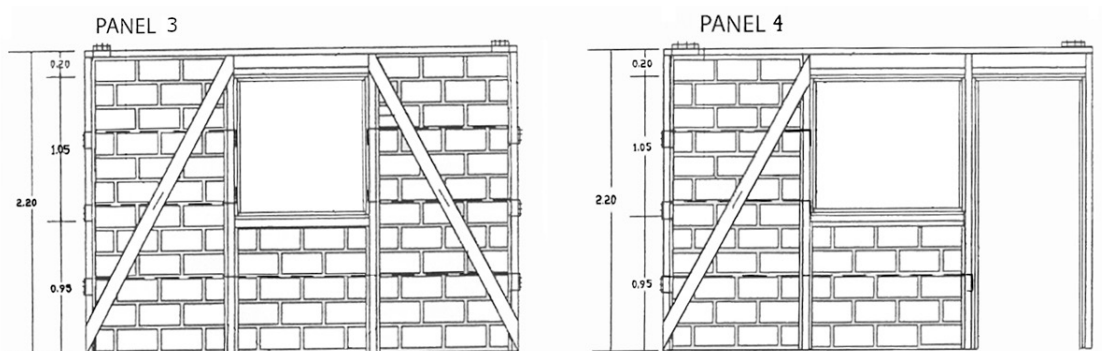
Paneles de muro LAD-MA 3 Y 4.
